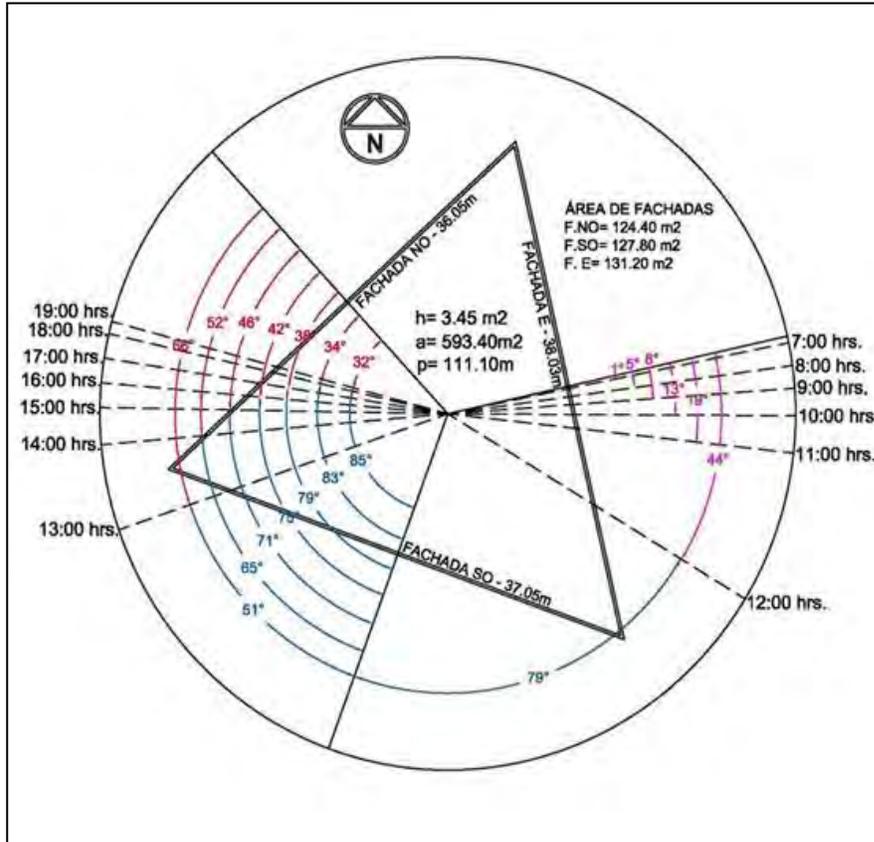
Ángulos de incidencia solar sobre las fachadas del edificio en planta para el mes de Mayo.
